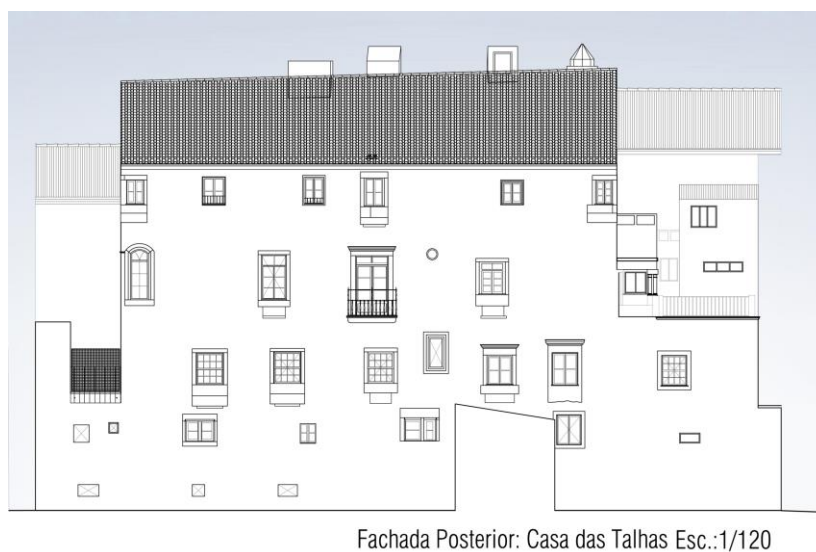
Fachada Posterior: Casa das Talhas – Esc.: 1:120
